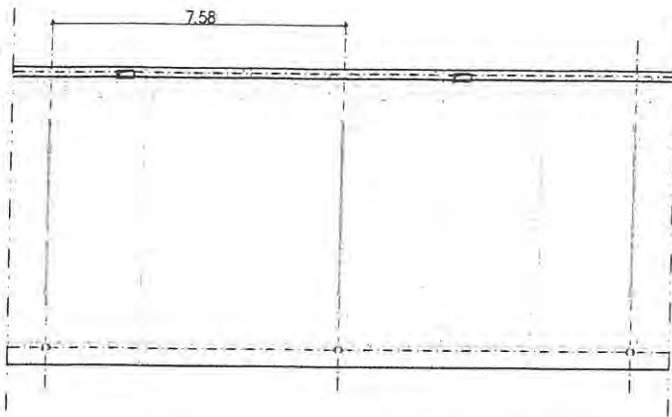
Variante 1: Deckenausschnitt Stahlfaserbeton vorgespannt, $d = 25$ cm, Beton C 35/45, Stahlfaserbeton F1,4/1,0, Durchbiegung 3,9 cm
